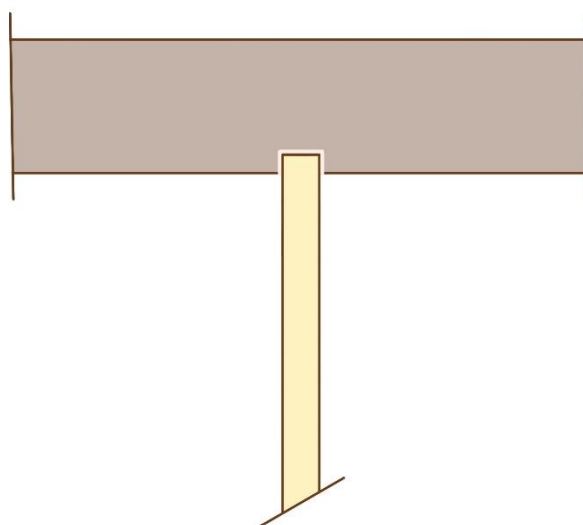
Dessin : Schéma d'un poteau en bois encastré dans une poutre en pierre, selon les pratiques constructives lyonnaises du début du XIX^e siècle. Le bois est logé dans une réservation taillée dans la pierre, puis calé et bloqué à la chaux Source : dessin de l'autrice.
